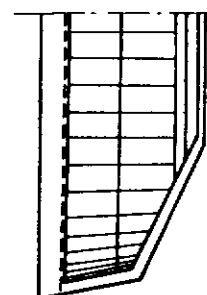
Detaliu de vîrf al palplanșelor din beton armat.
